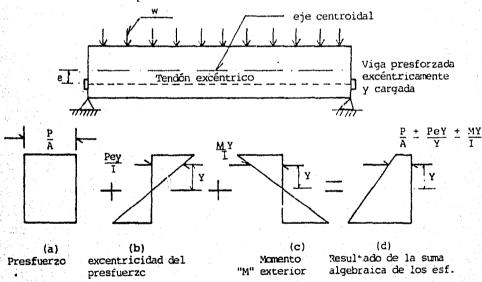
Distribución de esfuerzos a través de una sección de concreto presforzado, con una excentricidad igual a "e".
